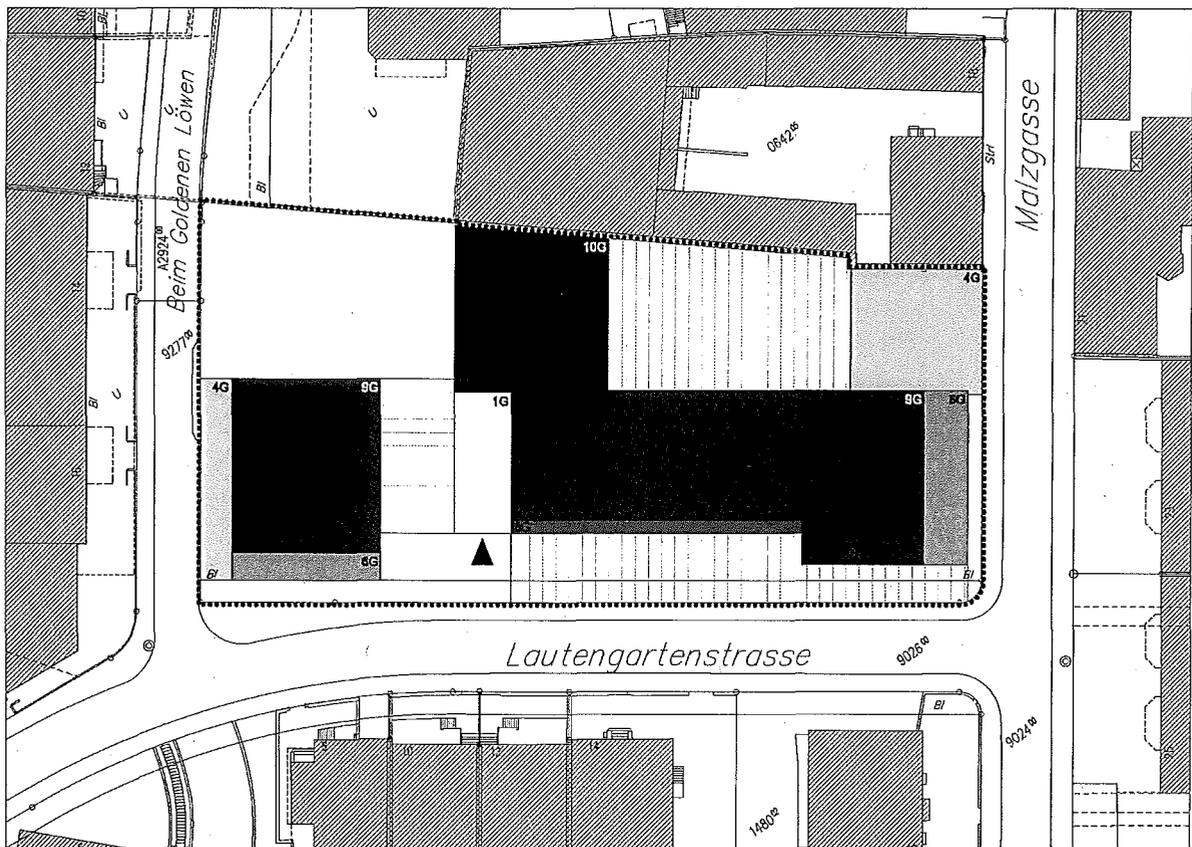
Bebauungsplan Plan-Nr. 13'324. (kein Massstab, Plan nicht genordet)
